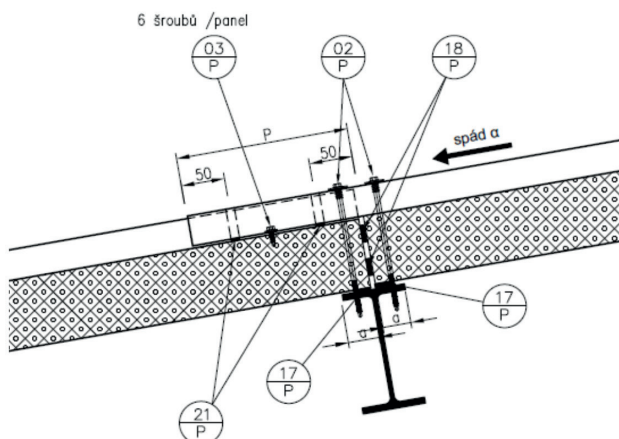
směr pokládky a pořadí kladení střešních panelů KS RW/FF
